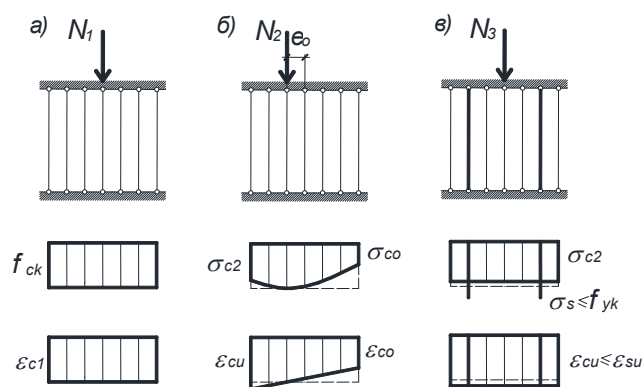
К перераспределению напряжений между отдельными фибрами сжатых бетонных и железобетонных элементов
